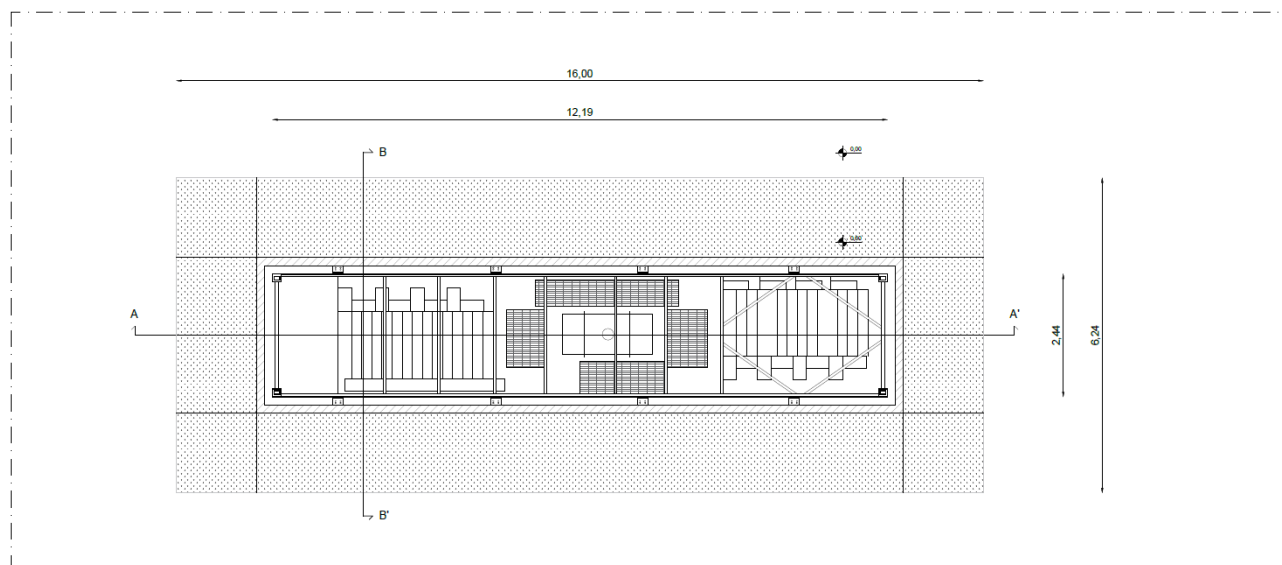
Planimetria in pianta piazzola cabine di trasformazione MT/BT
